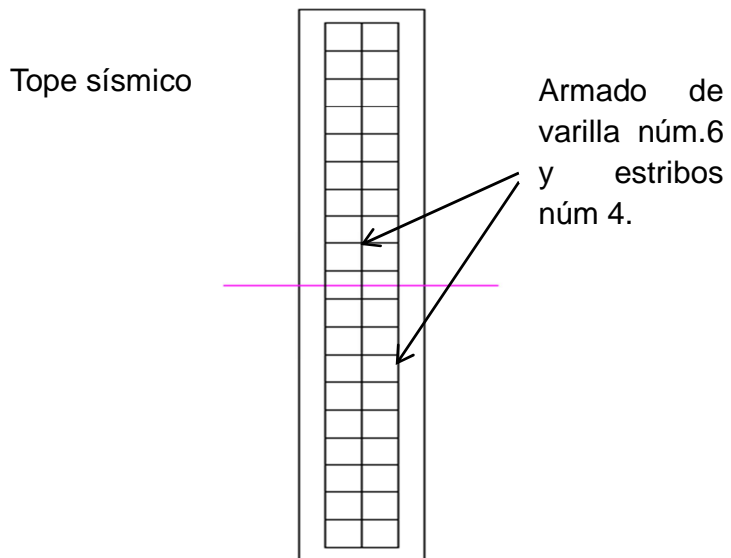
Detalle de armado de cabezal
